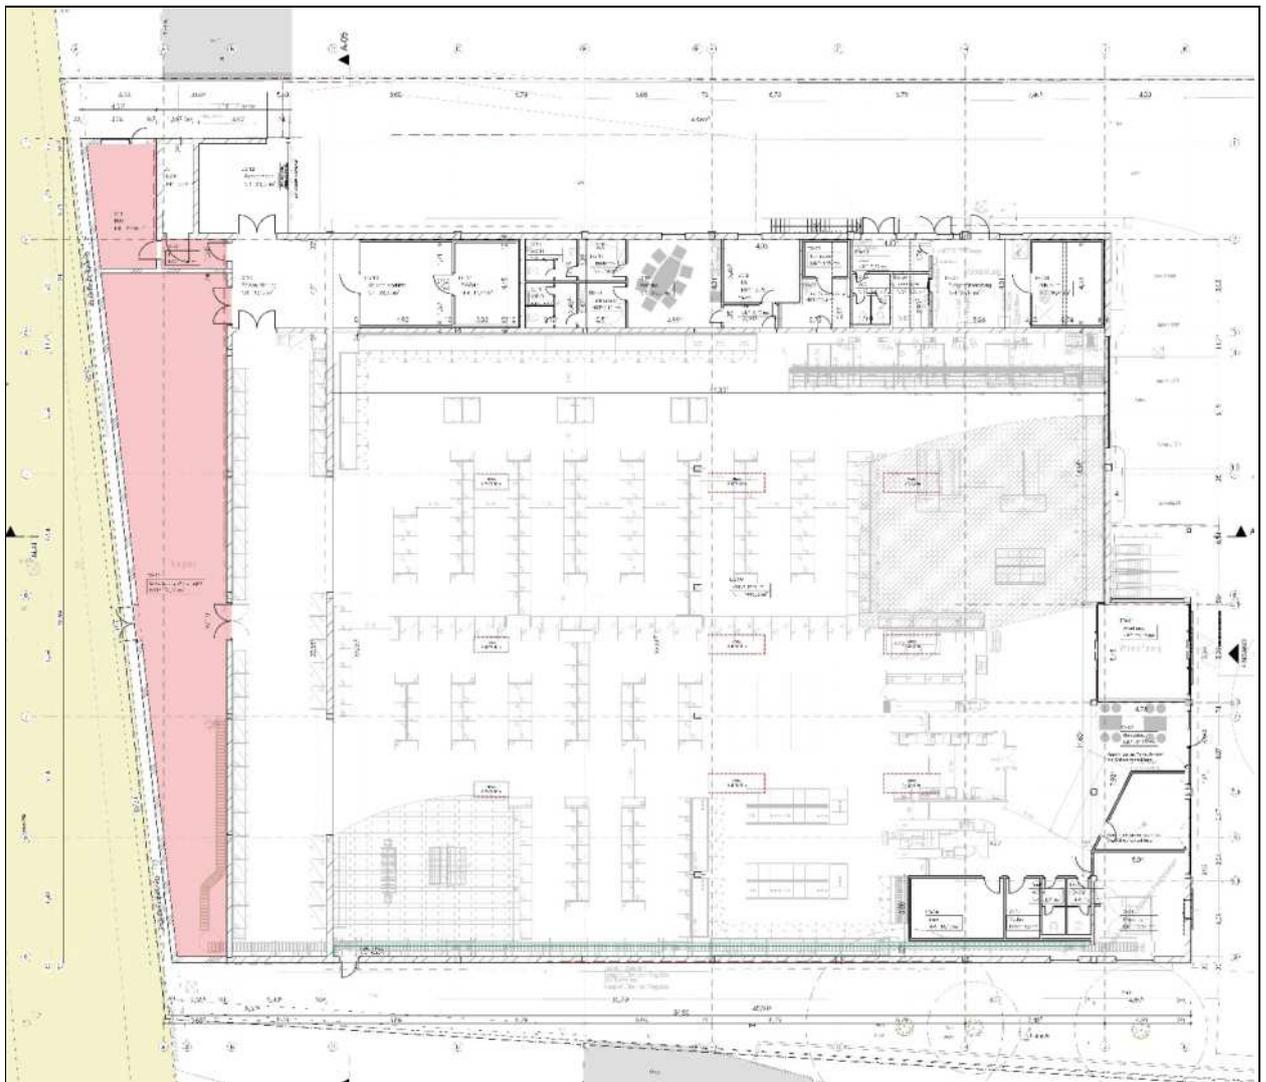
Lageplan mit Veränderung gegenüber der aktuellen Situation
